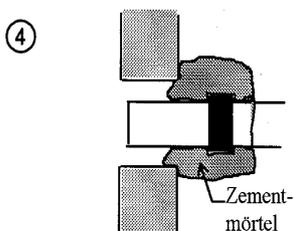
Das Stahlrohr wird entfernt. Beim Verfüllen des entstandenen Hohlraumes wird ein Verbund der Hausanschlussleitung mit dem Sammler angestrebt.
